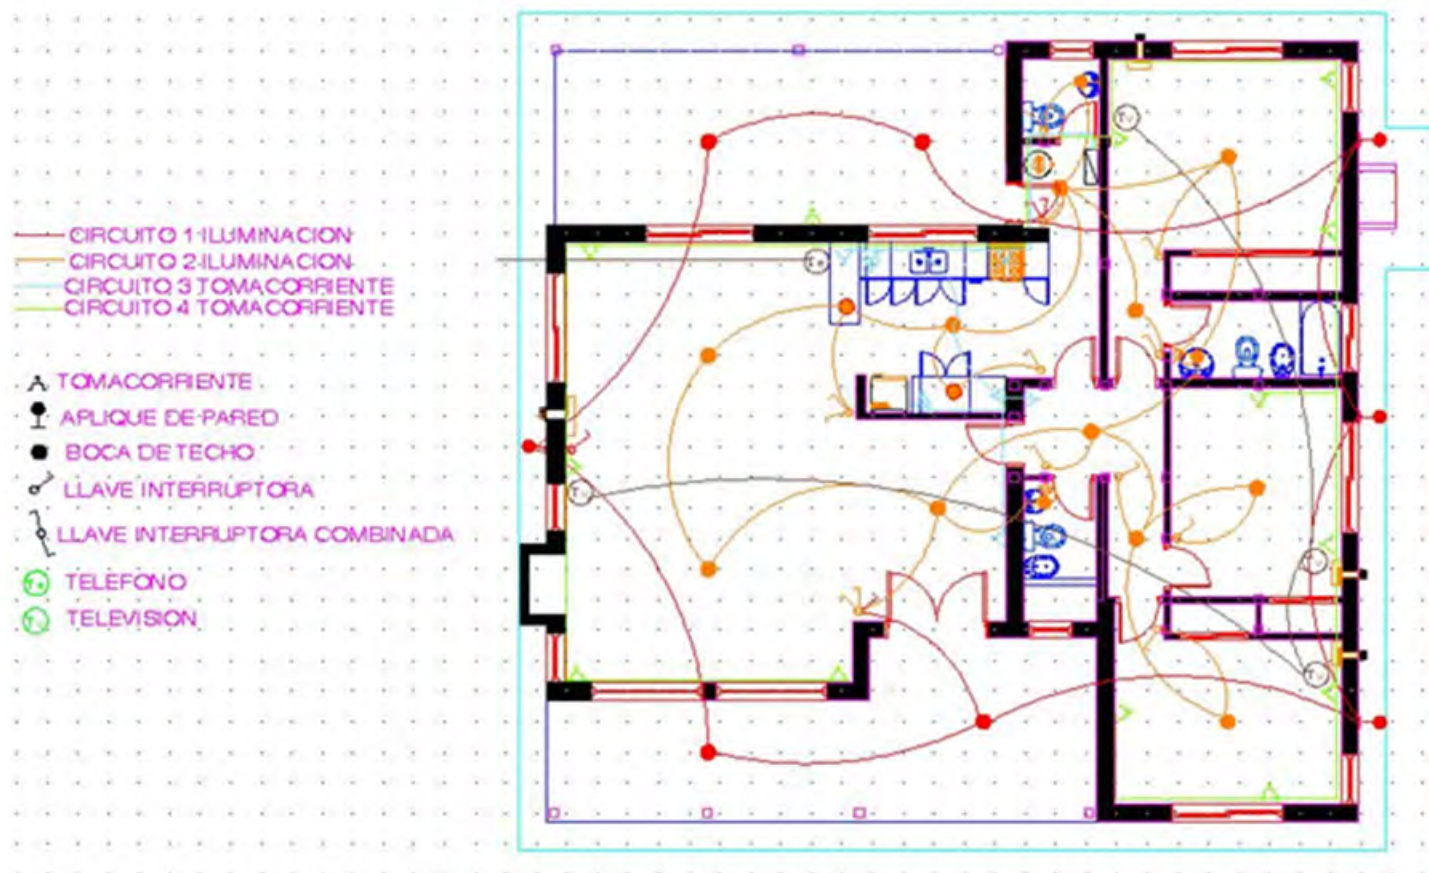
Plano tipo de una instalación eléctrica de una vivienda
